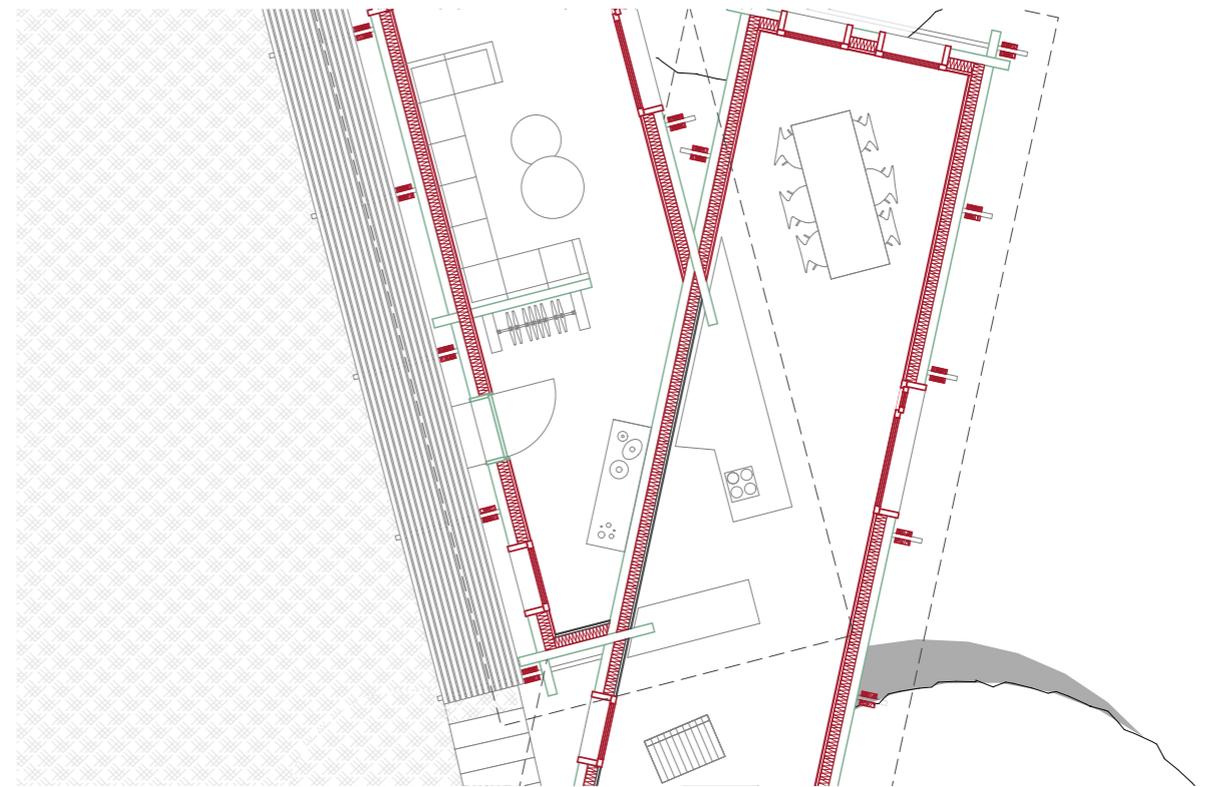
Vorentwurf | Grundriss 1:100
